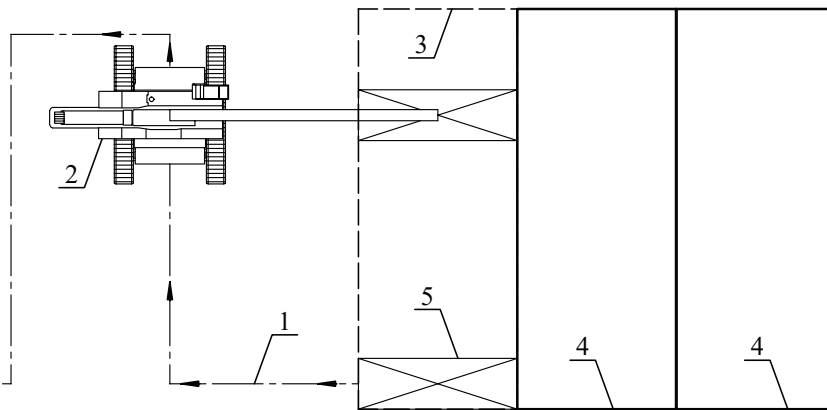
Пример определения пути движения крана при возведении надземной части здания при организации монтажных работ методом «на кран»:
